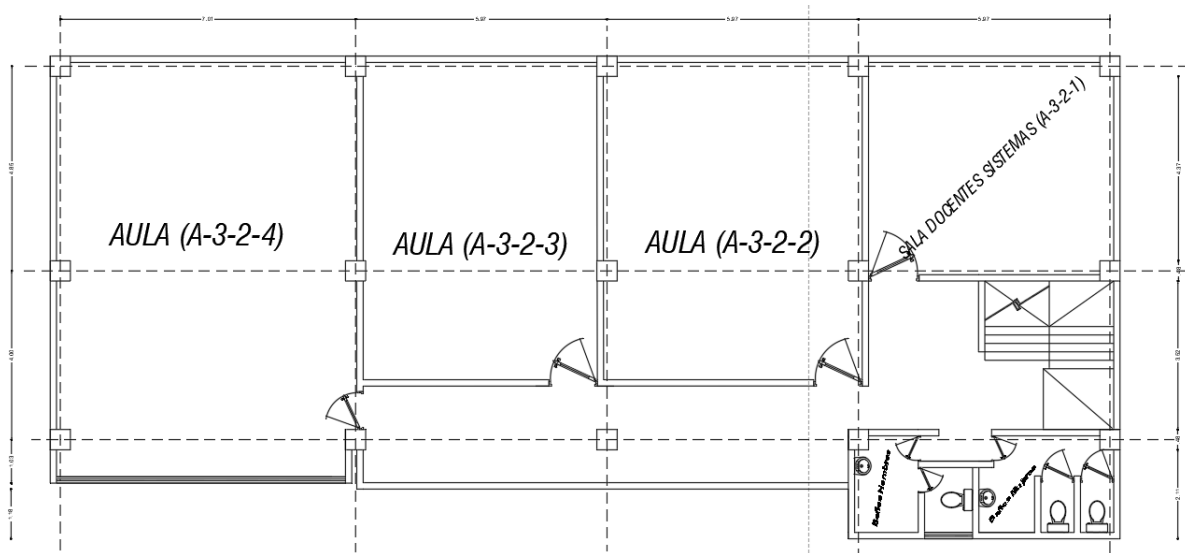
Primera planta alta se encuentra detallado el ambiente y codificación.
